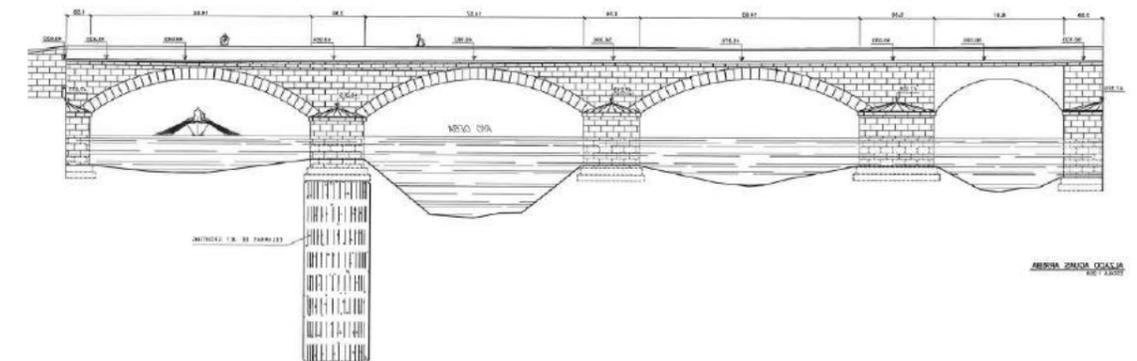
Plano del alzado de aguas arriba obtenido del proyecto de reparación de 2002 [2]. Se observa la solución planteada para la pila 1 utilizando *jet grouting*.
